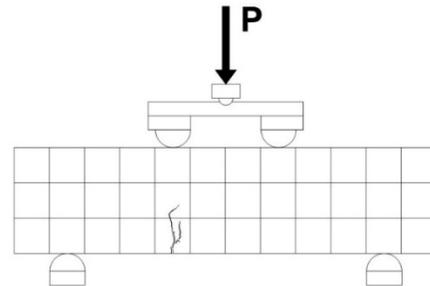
Uncracked Phase* pada Balok Beton BS02
